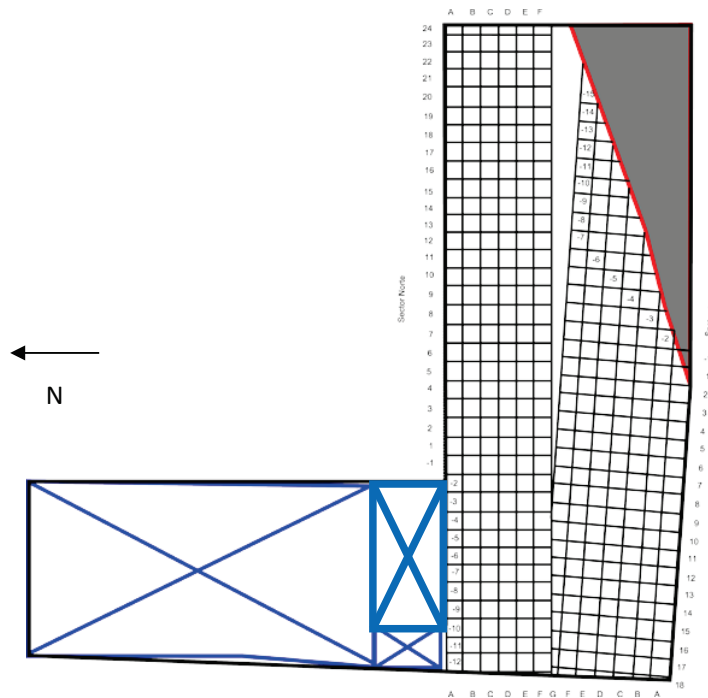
Planta de del Lote 18 mostrando el sistema de cuadrículado utilizado. En azul sótanos, en gris zona no excavada por no estar dentro del plan de obra civil.
